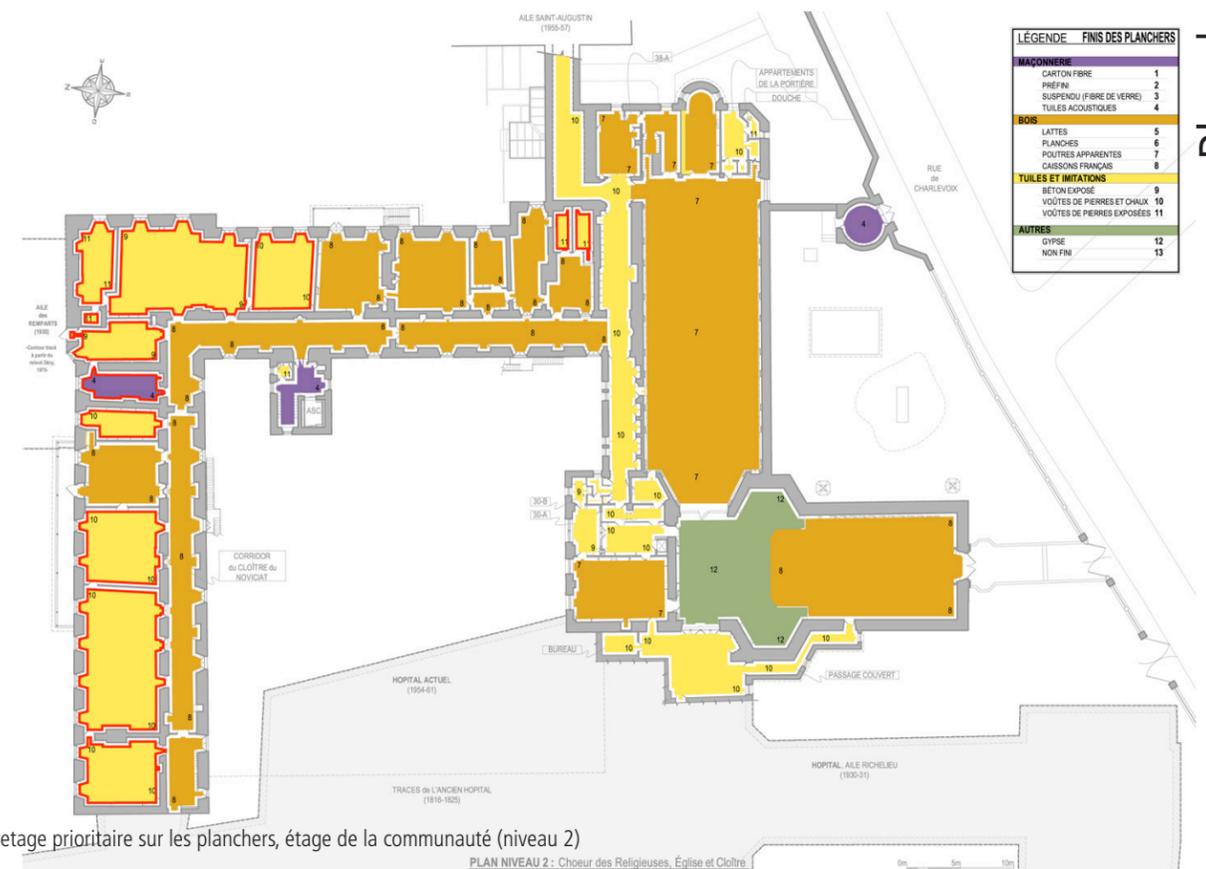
Plan de curetage prioritaire sur les planchers, étage de la communauté (niveau 2)
